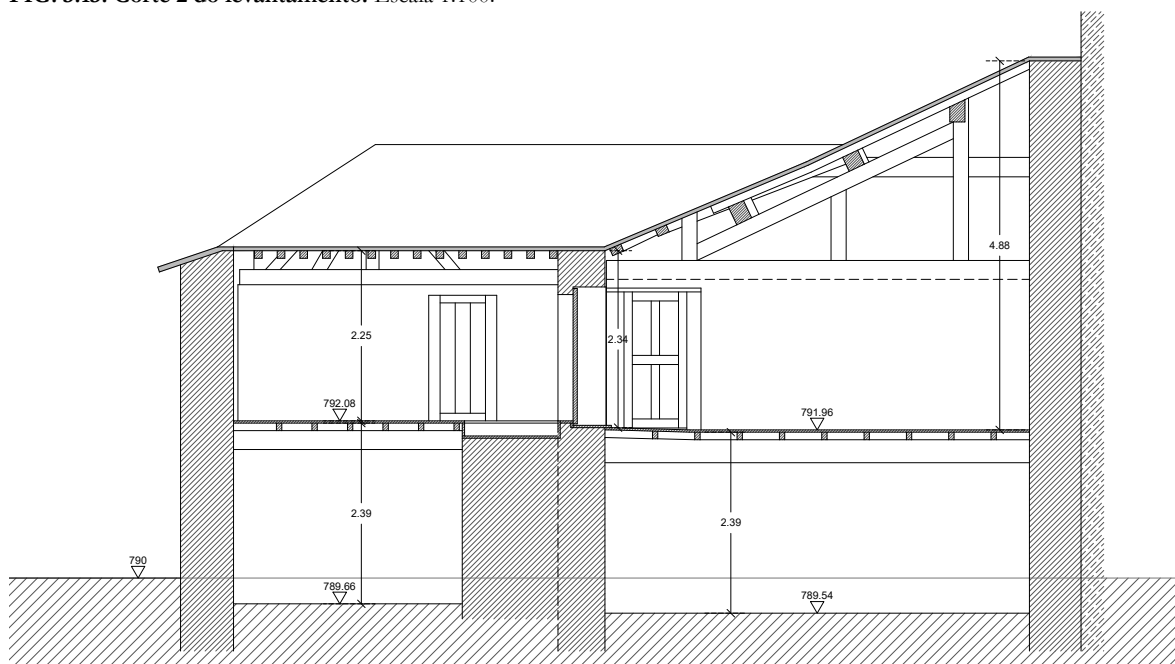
Corte 3 do levantamento. Escala 1:100.
